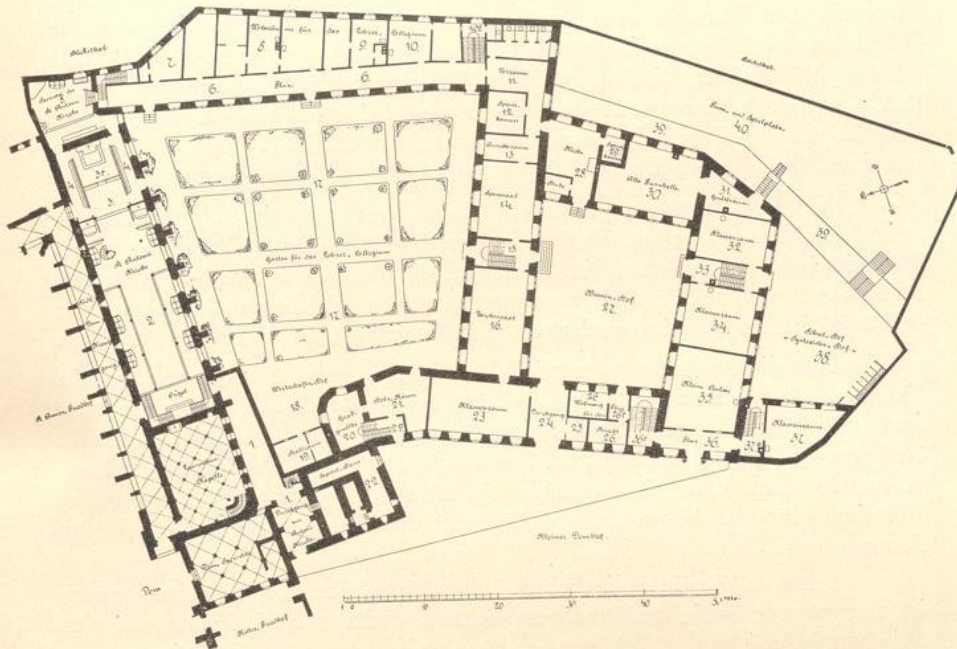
Gymnasium Josephinum. Grundriß (Faksimile nach Balkenholl, S. 34).
